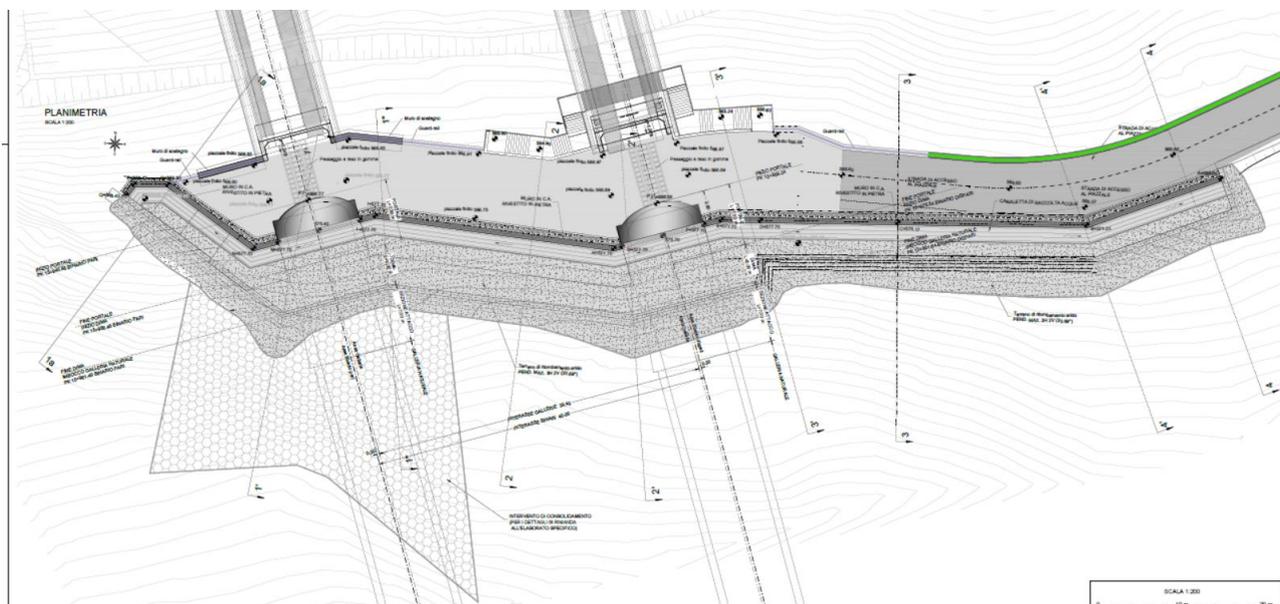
Imbocco Nord – Planimetria delle opere in fase definitiva
